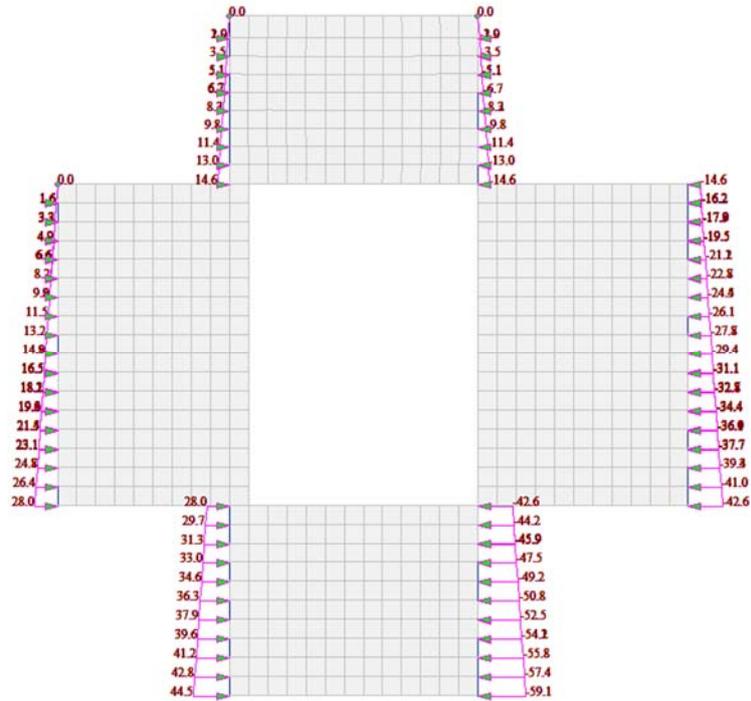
Spinte del terreno in direzione Y (pareti X)
